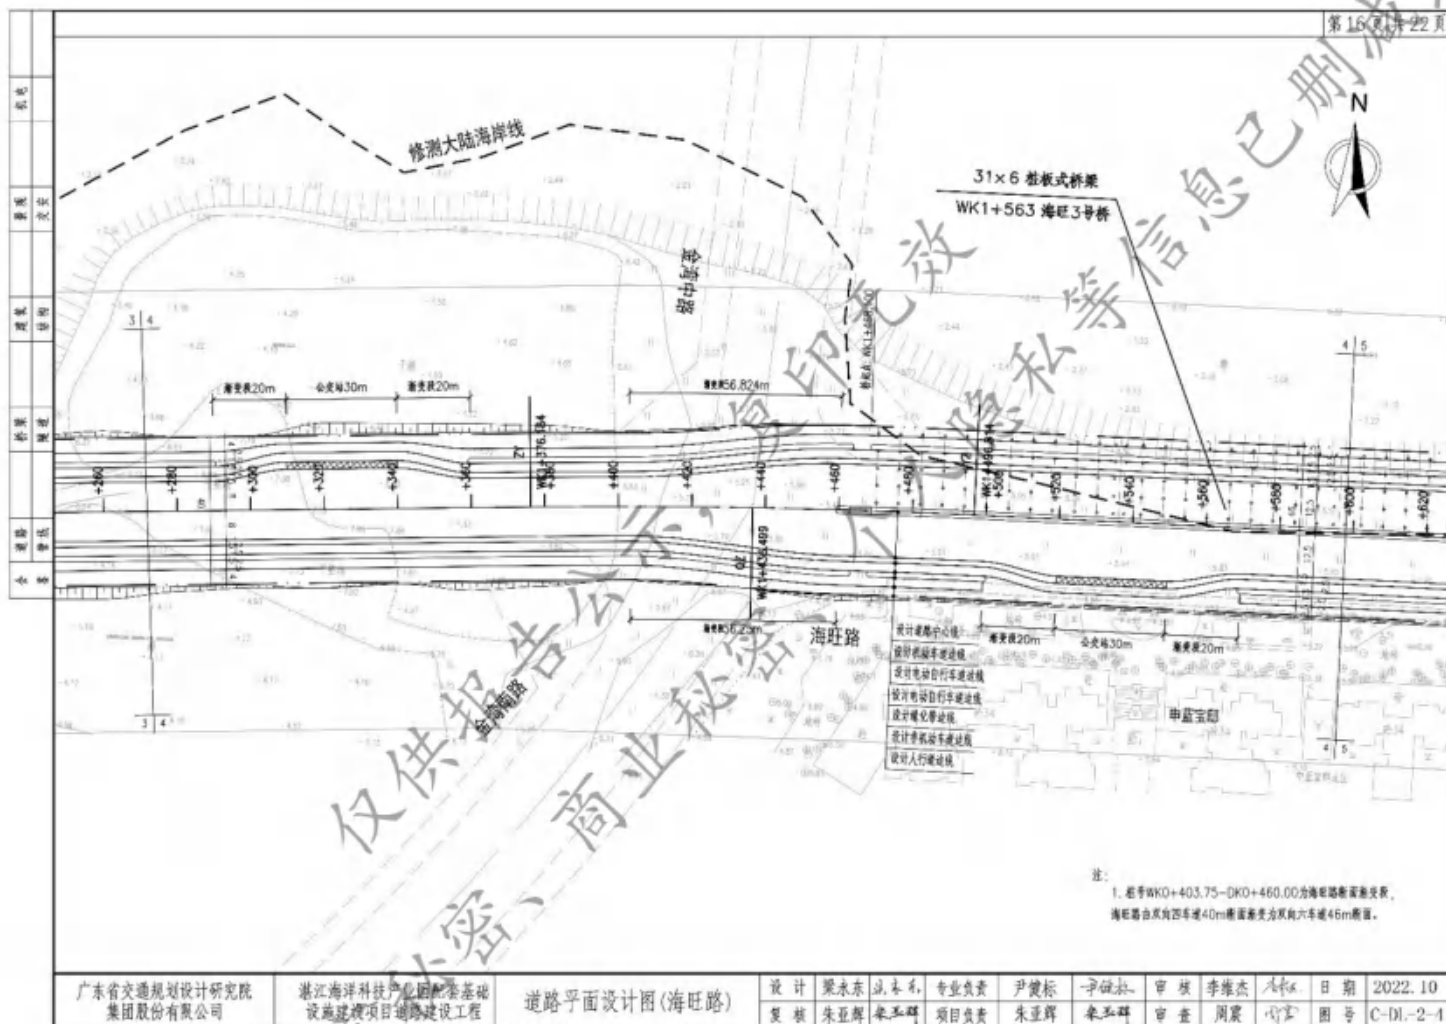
海旺路 3 号桥总平面布置图 (2)
